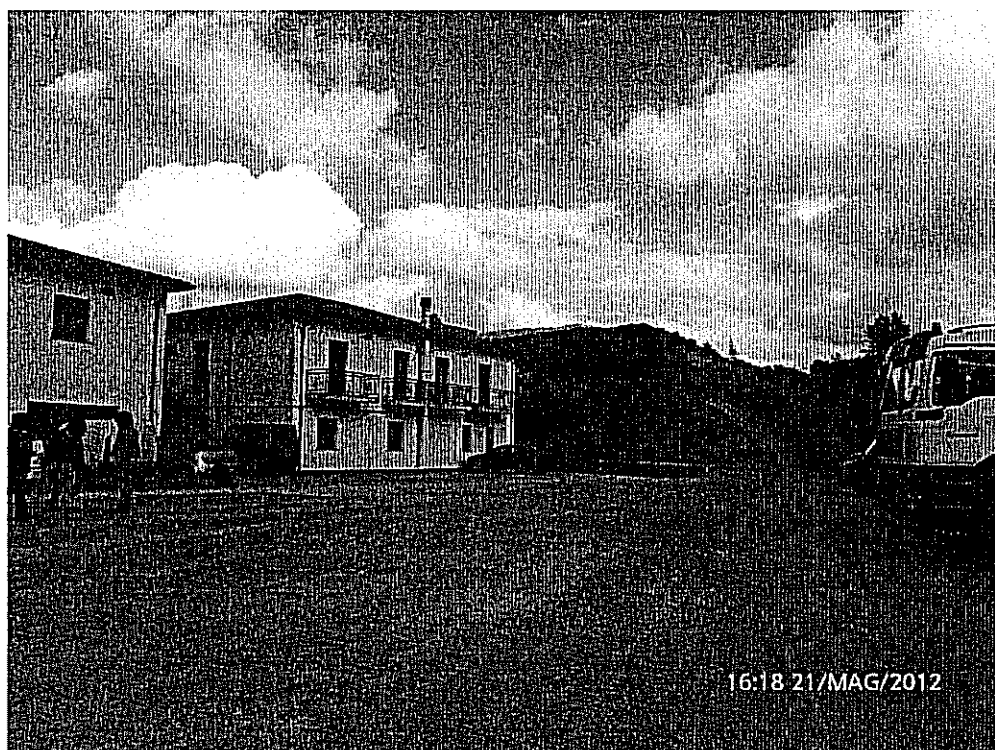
Fabbricato uffici e servizi, blocco lato destro
